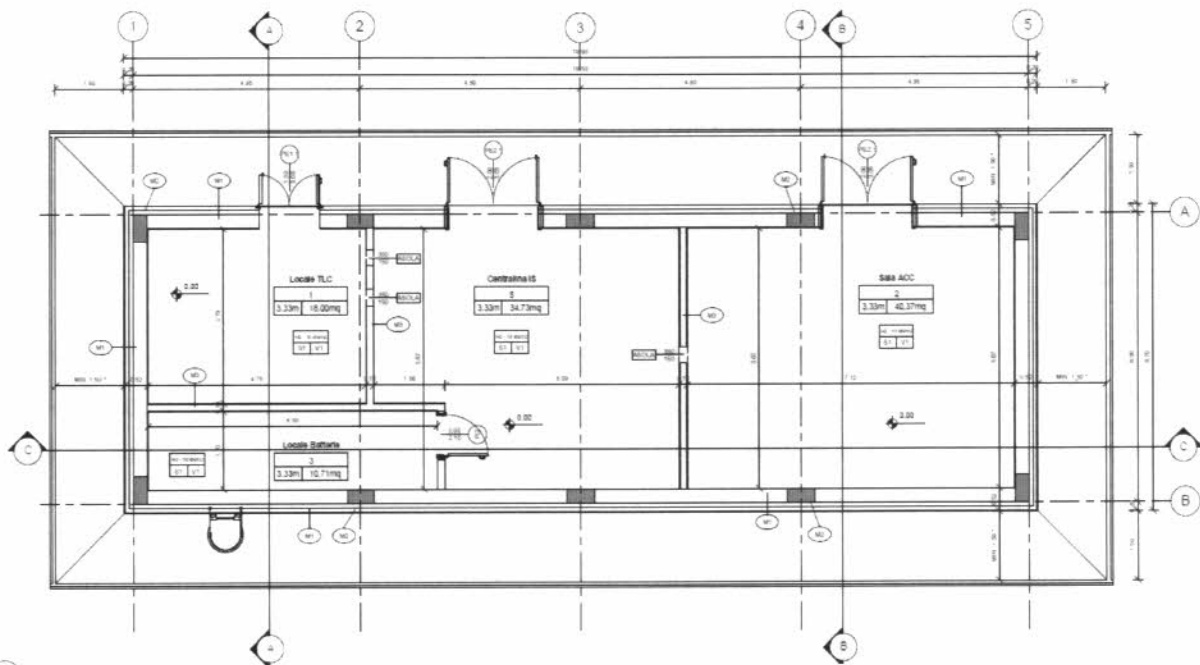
Pianta Architettonica Piano Terra – Layout T4.A
